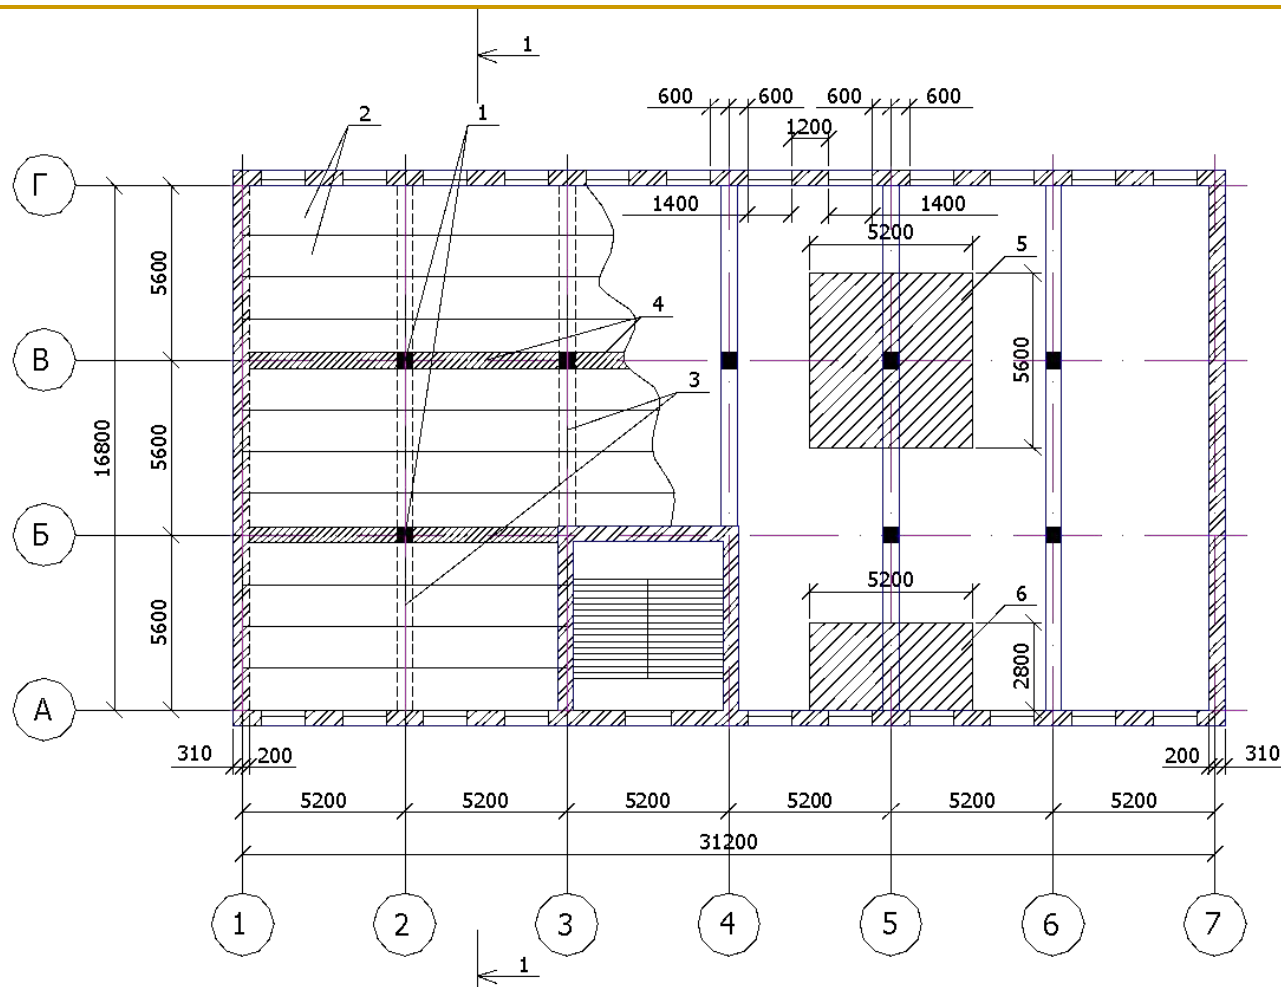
План перекрытия многоэтажного каменного здания: 1- средние опоры перекрытия – каменные столбы; 2 – плиты перекрытия; 3 – железобетонные ригели; 4 – монолитные участки перекрытия; 5 – грузовая площадь каменного столба; 6 – грузовая площадь простенка и стены подвала
